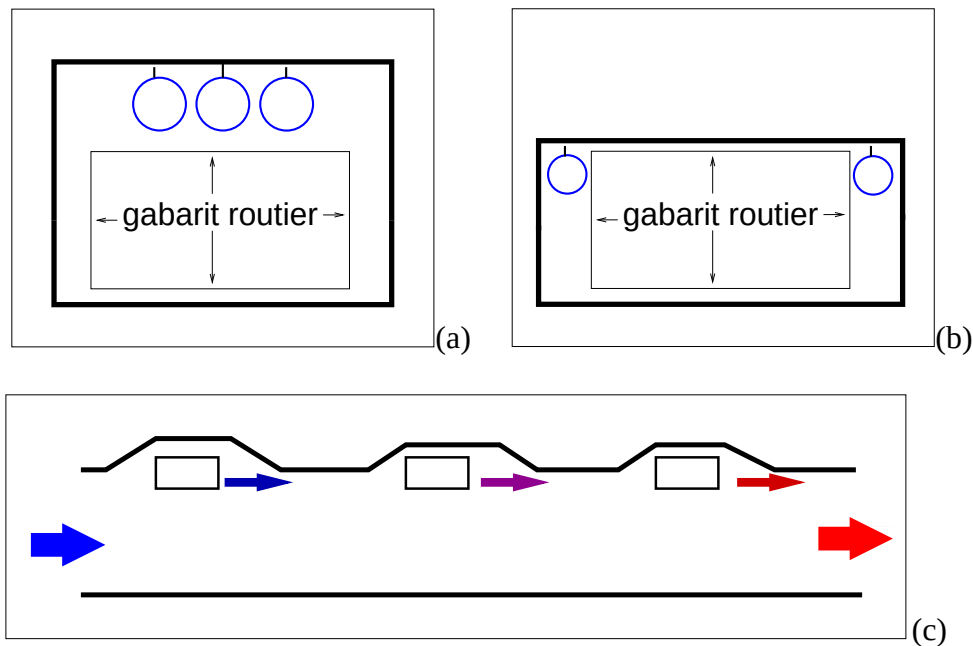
Exemples d'implantation de ventilateurs pour un tunnel à section rectangulaire ((a) et (b) : coupe en travers ; (c) profil en long ; la solution (b) n'est pas recommandée.
